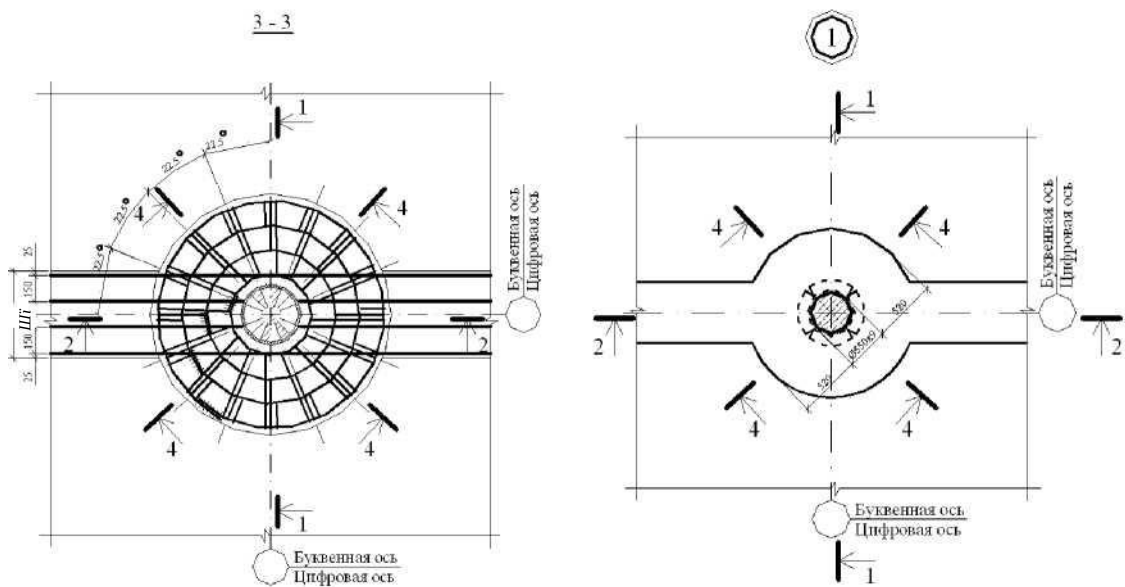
Планка примикання трубобетонна з ригелем:
